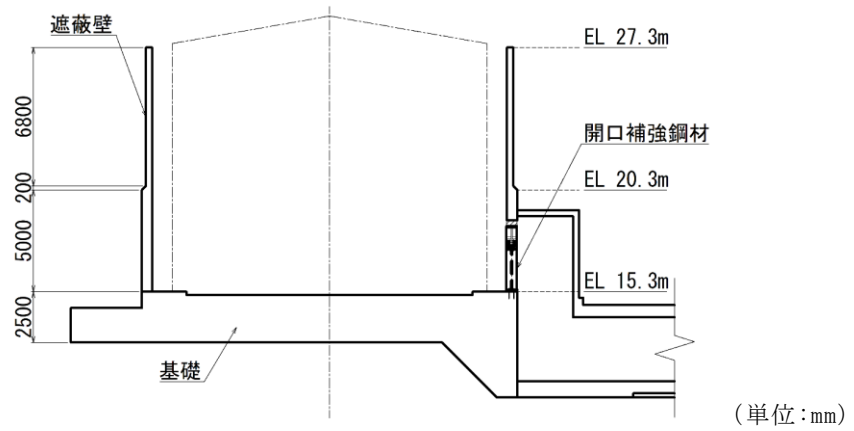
復水貯蔵タンク遮蔽壁 断面図 (A-A 断面)
